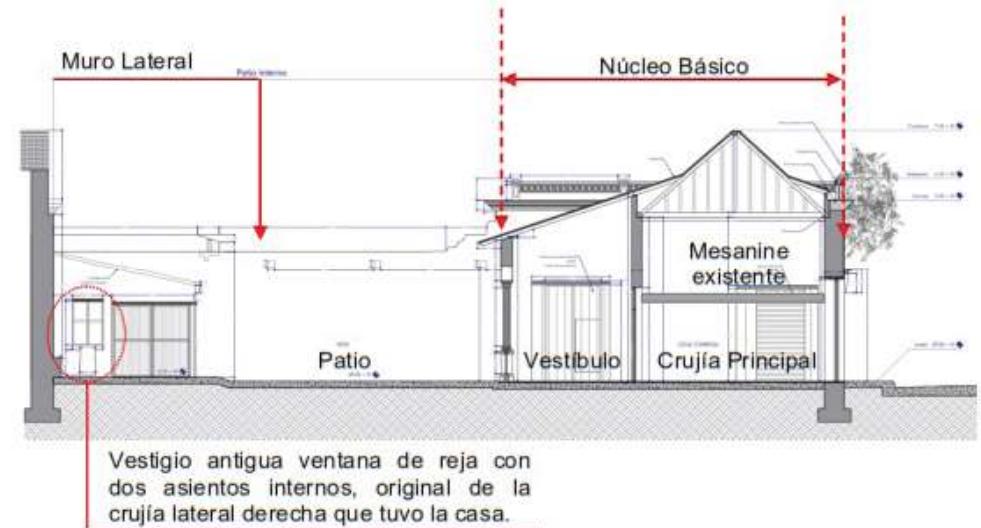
Cortes longitudinal y transversal casa “Landinez”. Fuente: Levantamiento arquitectónico casa “Landinez”, elaboración propia y Andrés Felipe Mendoza.
